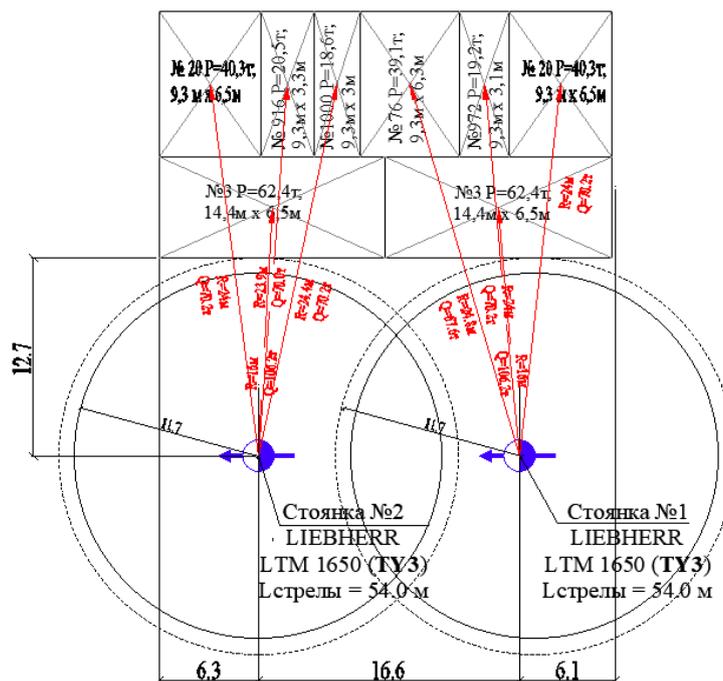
Схема имитационного моделирования механизации монтажных работ мобильным краном на спецшасси для односекционного прямоугольного жилого здания «Тип 2». План
